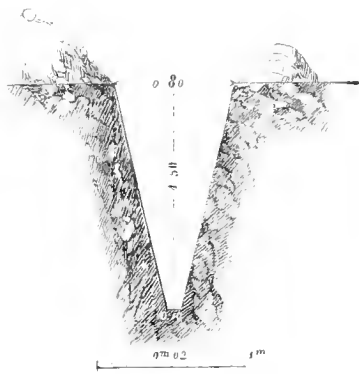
Coupe d'une tranchée profonde dans un terrain pierreux.
